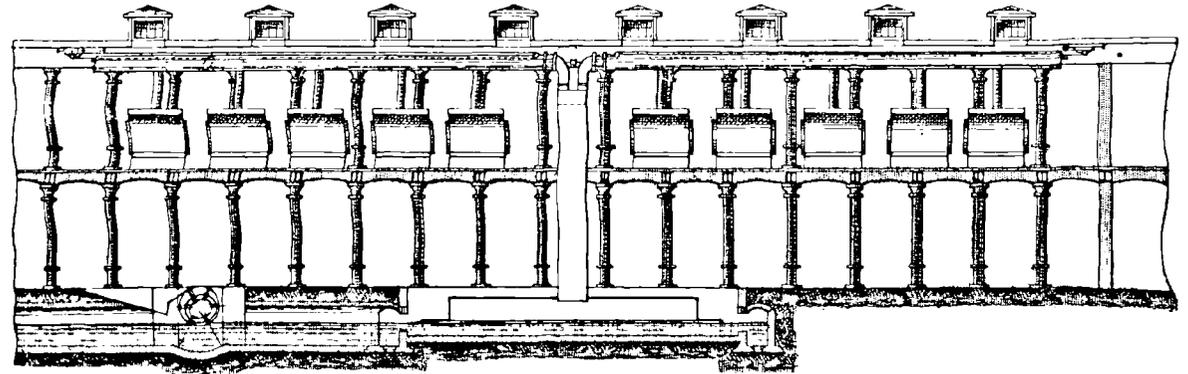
Ventilation des ateliers de cardage. (Coupe longitudinale).
